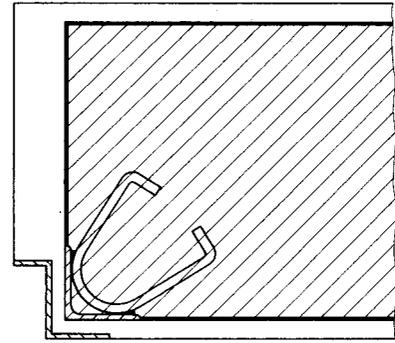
Anschweißanker, Einbaubeispiel (Grundriß) dicke Wand, allseitig geputzt, Befestigung der Zarge am Anschweißanker mittels Paßstücken und Schweißung (nicht dargestellt)
